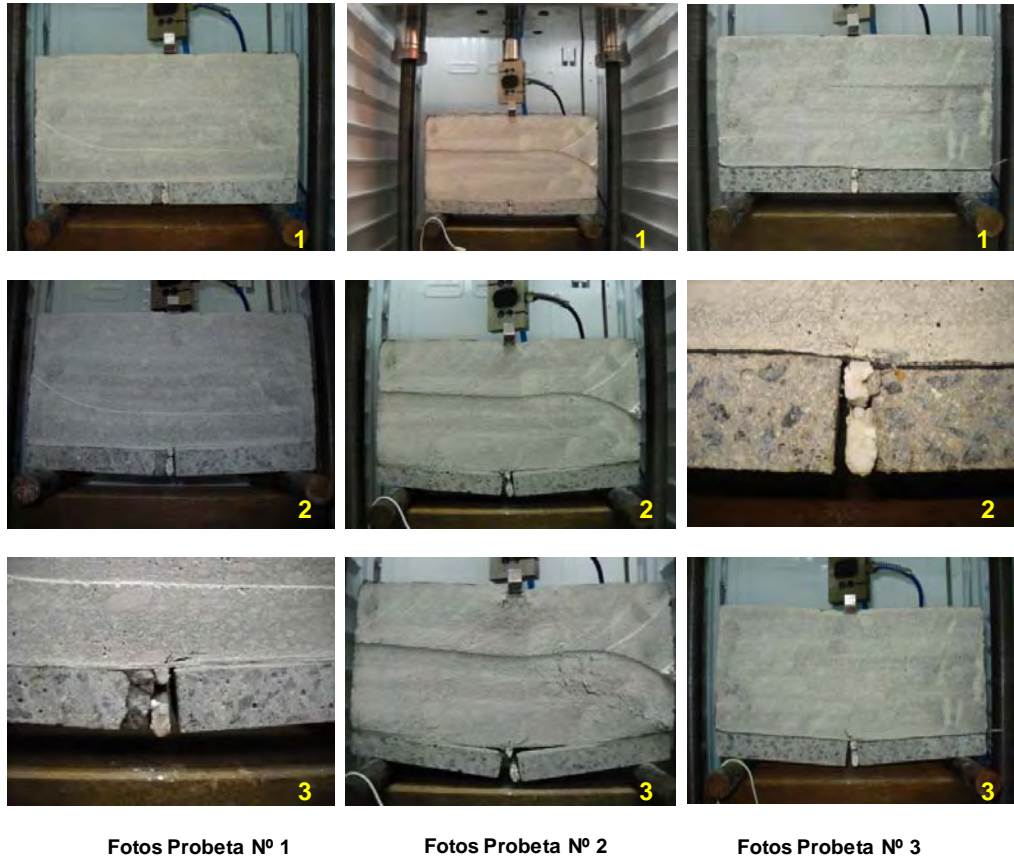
Secuencia de fisuración para la probeta 1, probeta 2 y probeta 3 para el sistema 2
